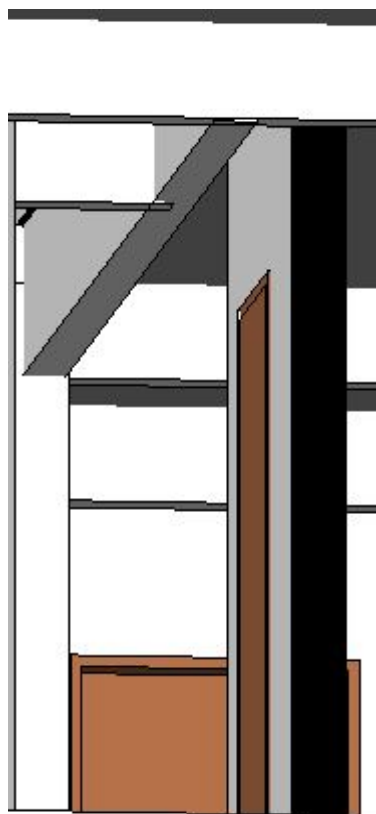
Demonstração da viga V9 passando sob o banheiro, em planta
